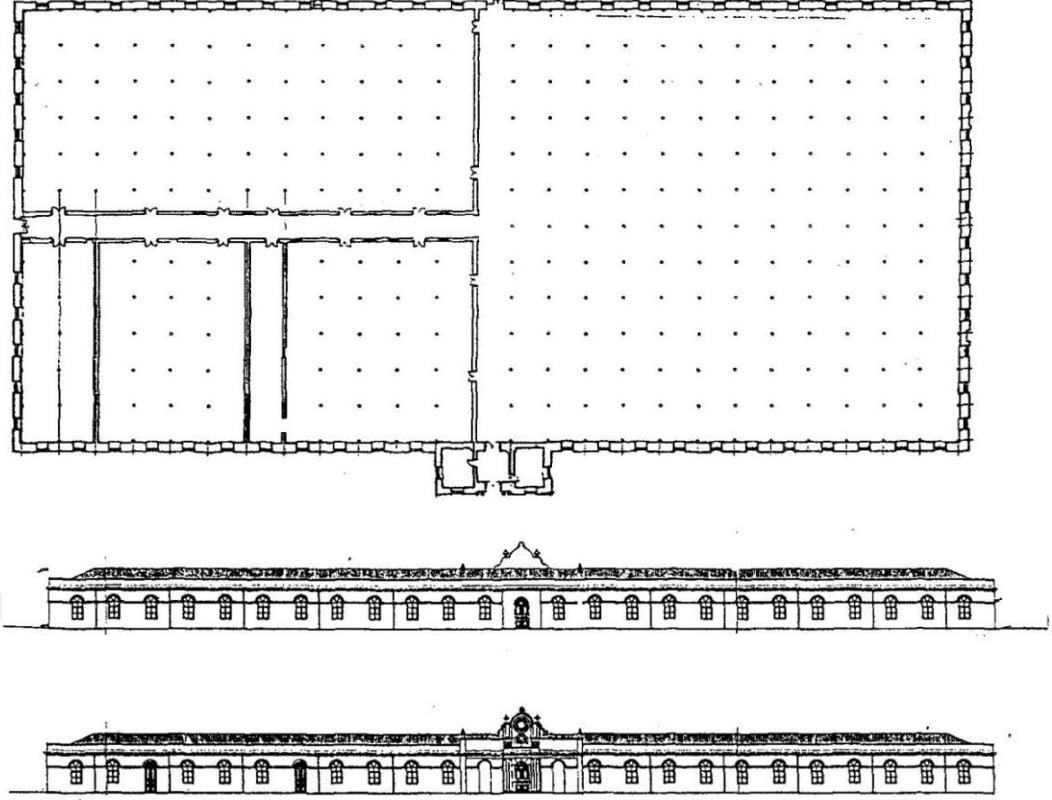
Küçükçekmece Kibrit Fabrikası, plan ve cephe rölövesi (Kıraç, 2001).
